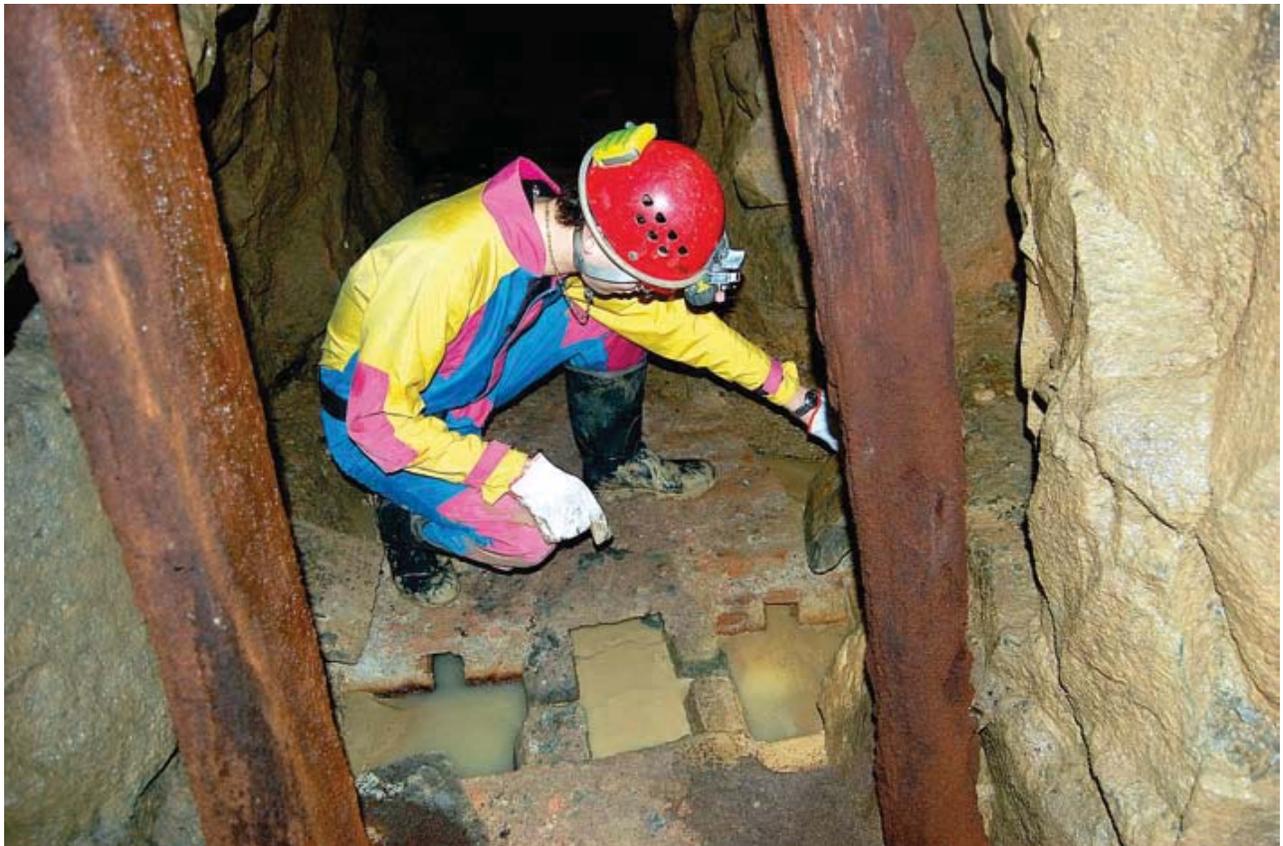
Travi di puntellamento in legno nelle Gallerie Superiori - Punto n. 7 nella planimetria generale.
